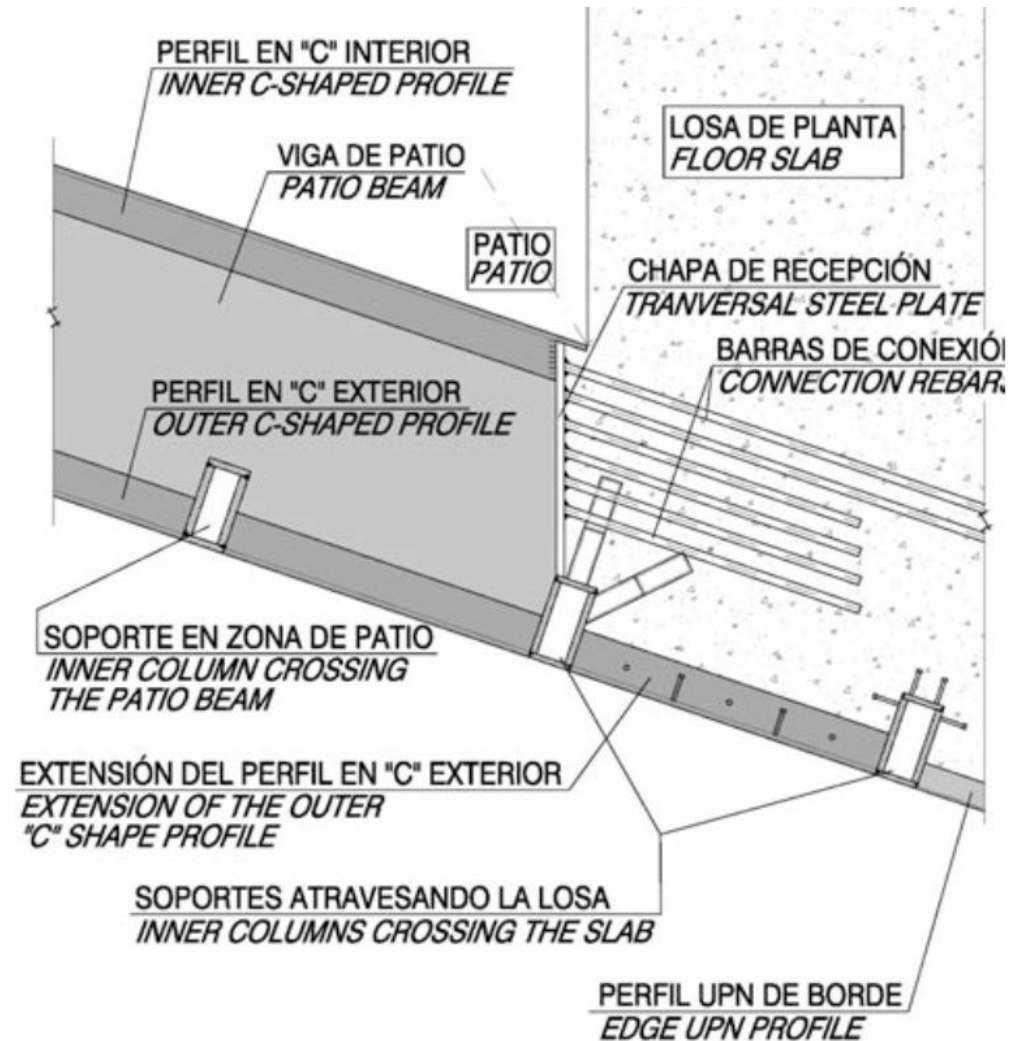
Detalle continuidad de la viga de patio y losa
